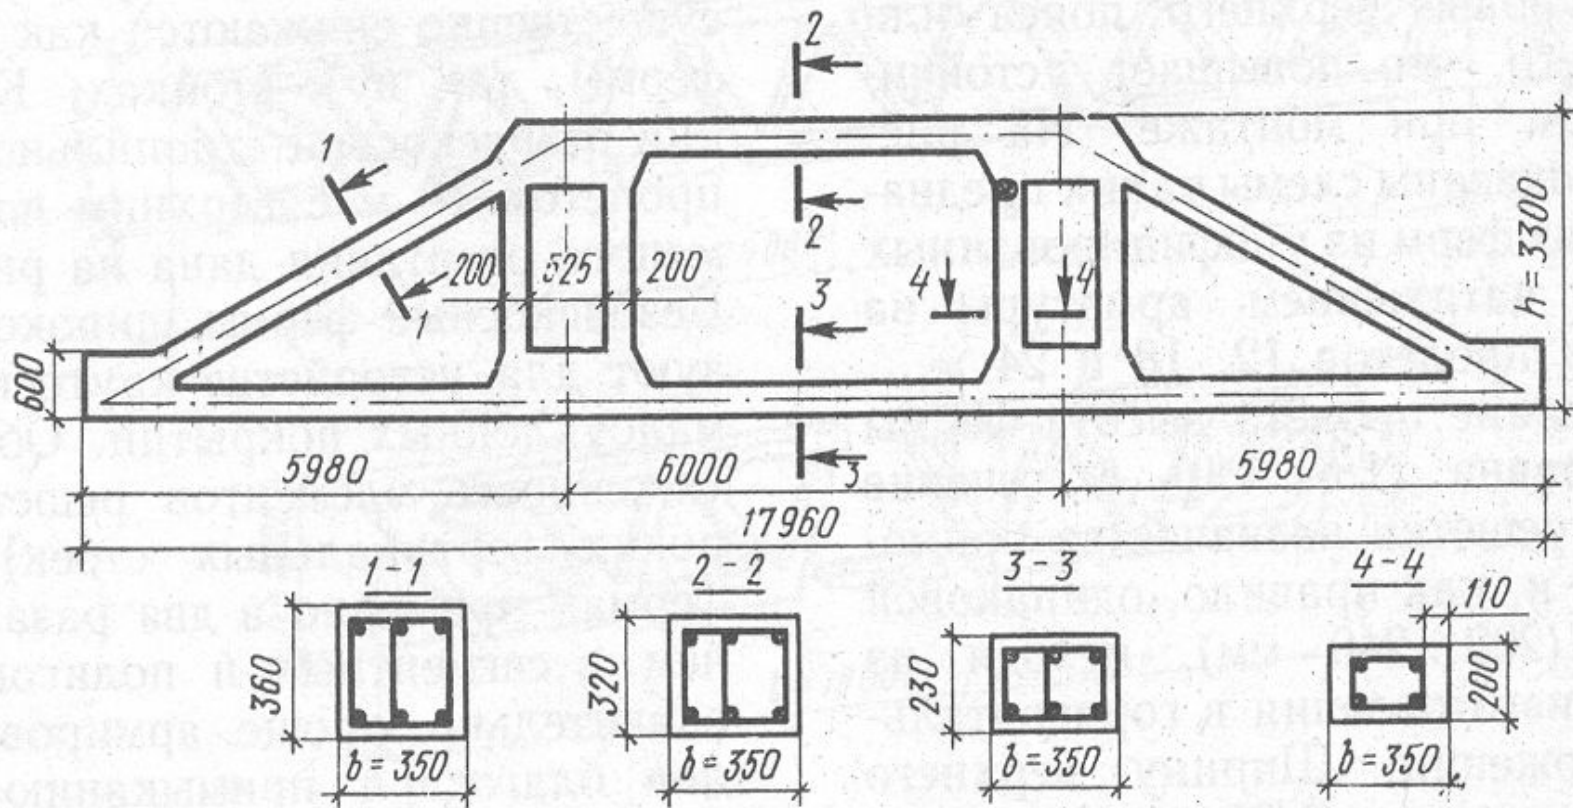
Безраскосная подстропильная ферма пролетом 18 м
